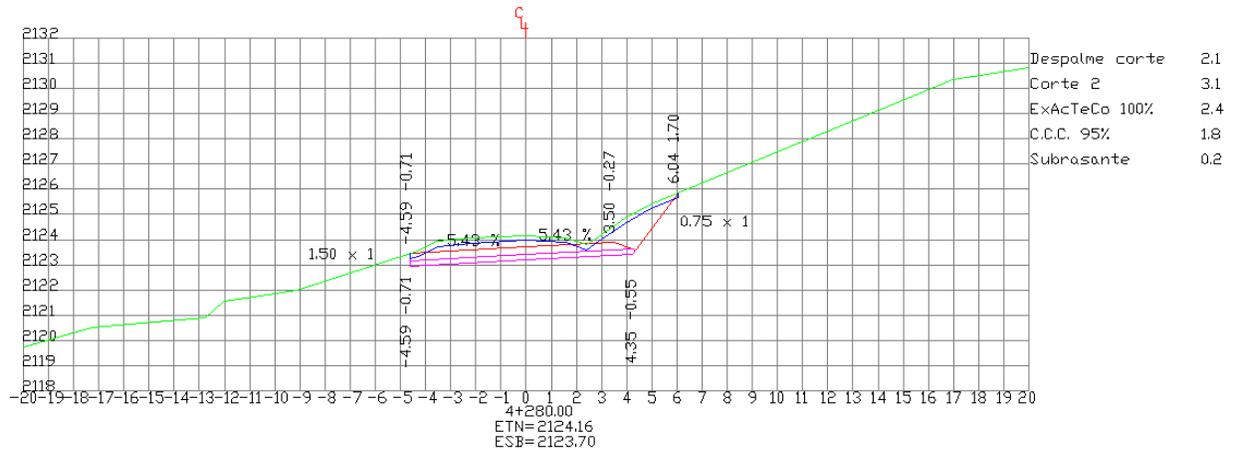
Sección transversal, km 4+280, en zona donde se requiere defensa metálica lado izquierdo.
